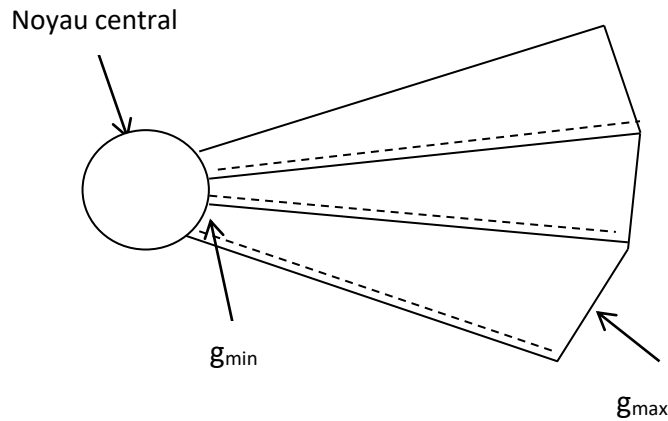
schéma d'encastrement de la marche dans un pilier central
